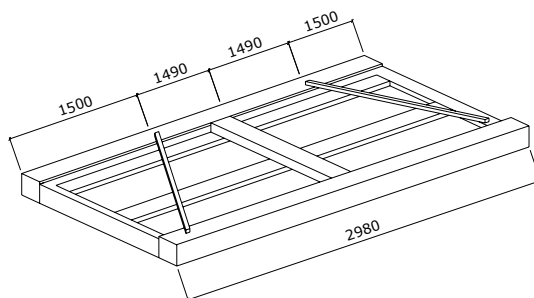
Плита покриття на дерев'яному каркасі з клеєних профільних ребер
